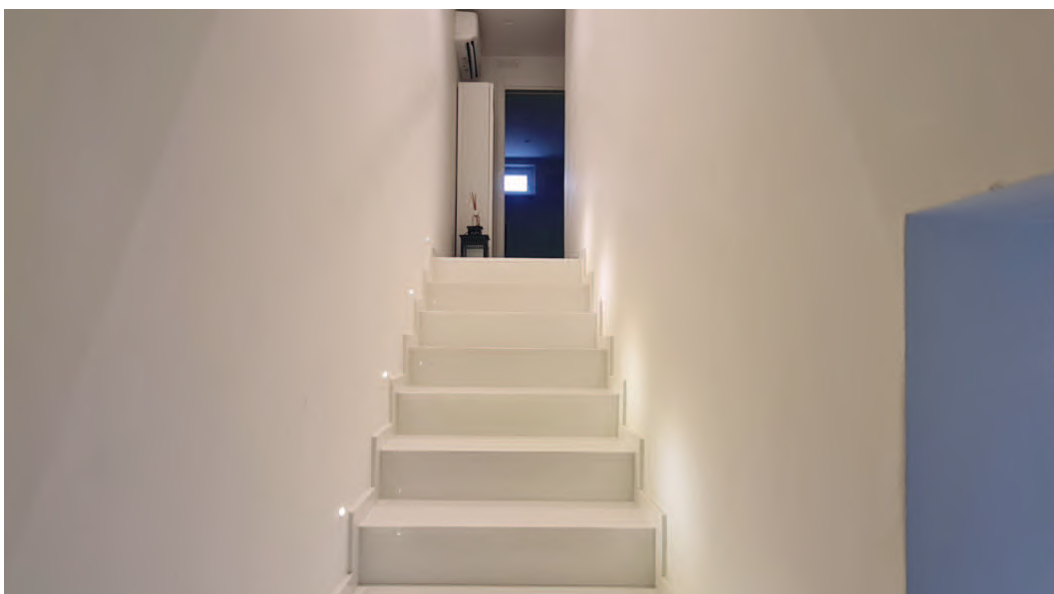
Scala interna di collegamento tra piano secondo e terzo
